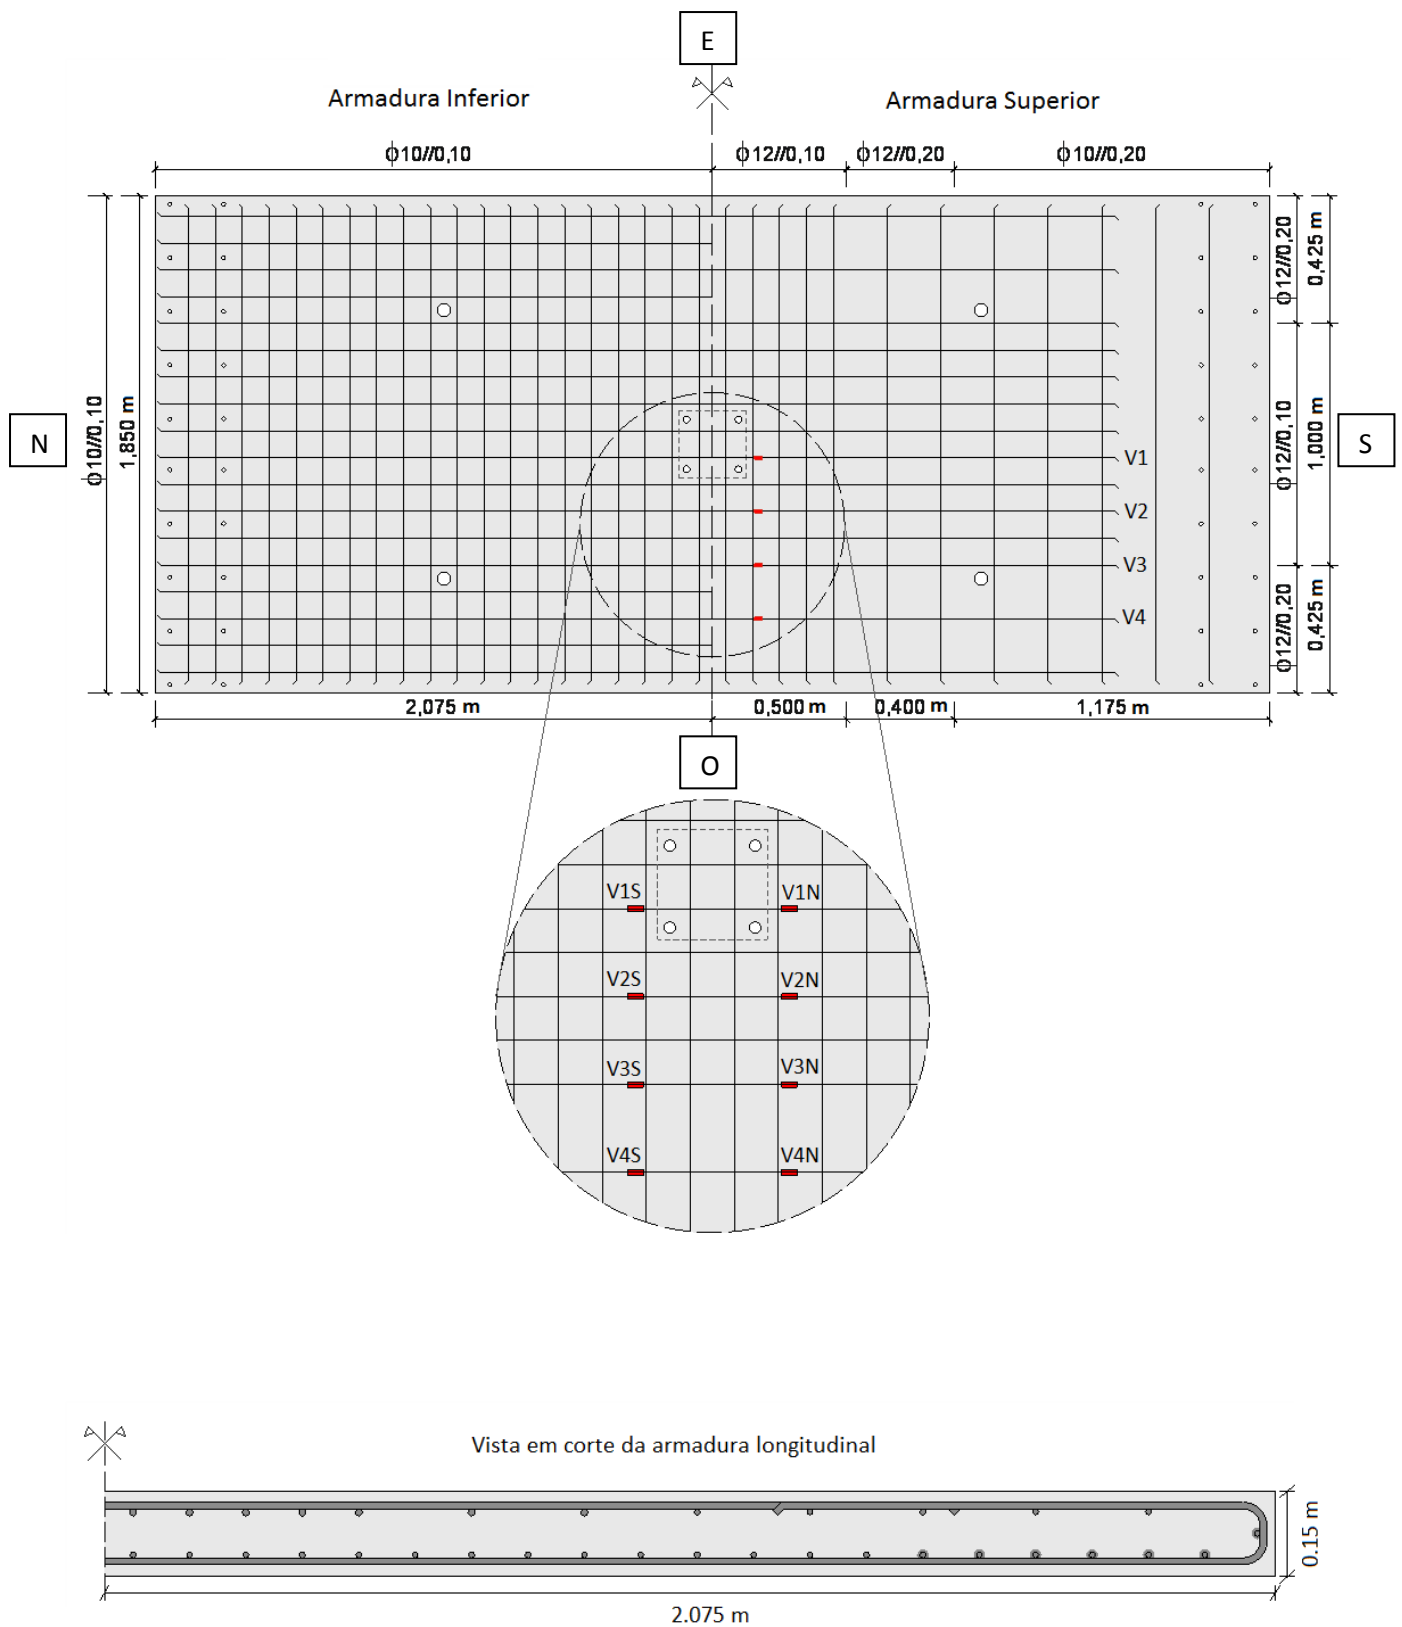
Pormenorização da armadura inferior e superior (em cima). Localização dos extensómetros na armadura longitudinal superior (pormenor) Vista em corte da armadura longitudinal (em baixo).
